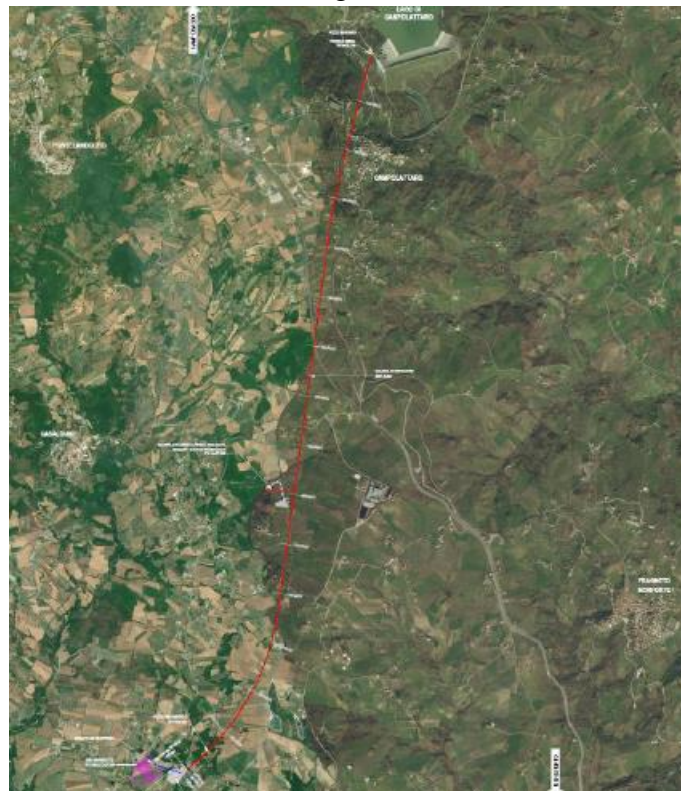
Planimetria delle opere previste dal Progetto (cfr. Relazione Tecnica, Galleria di derivazione e opere connesse).
